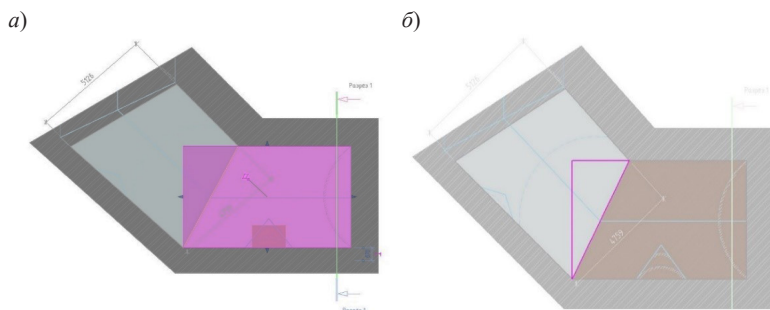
Этапы создания правого сегмента сводчатого перекрытия, виды в плане:
